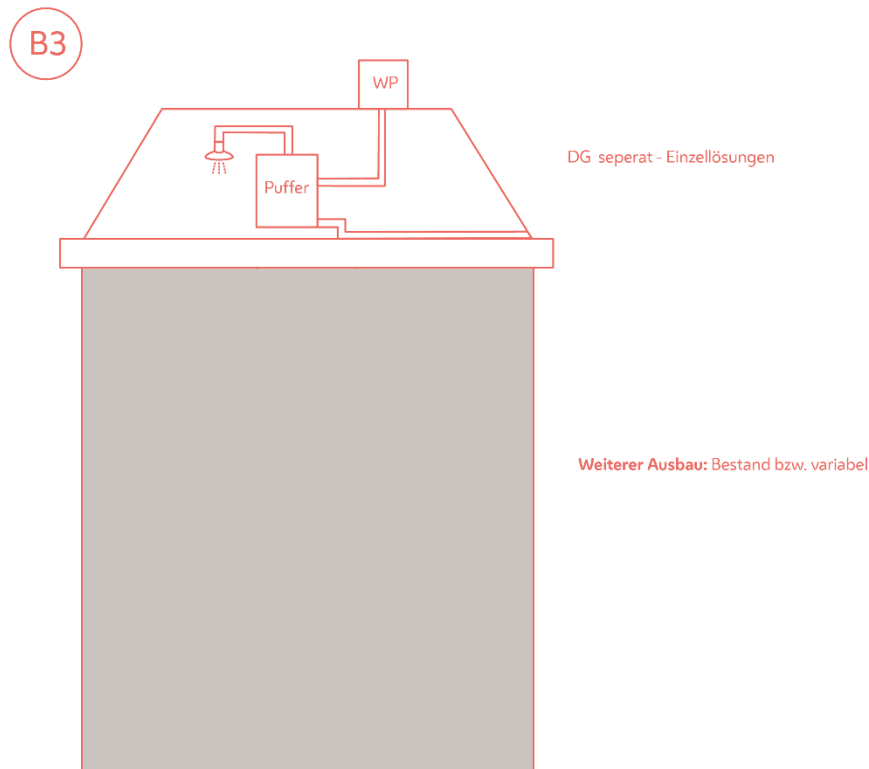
Variante B3 Einzellösungen für separate Dachgeschossausbauten (Quelle: eigene Darstellung).
